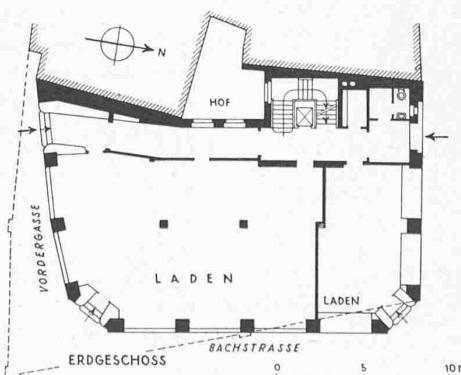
Neubau «Zur Platte» in Schaffhausen. Grundriss 1:400
